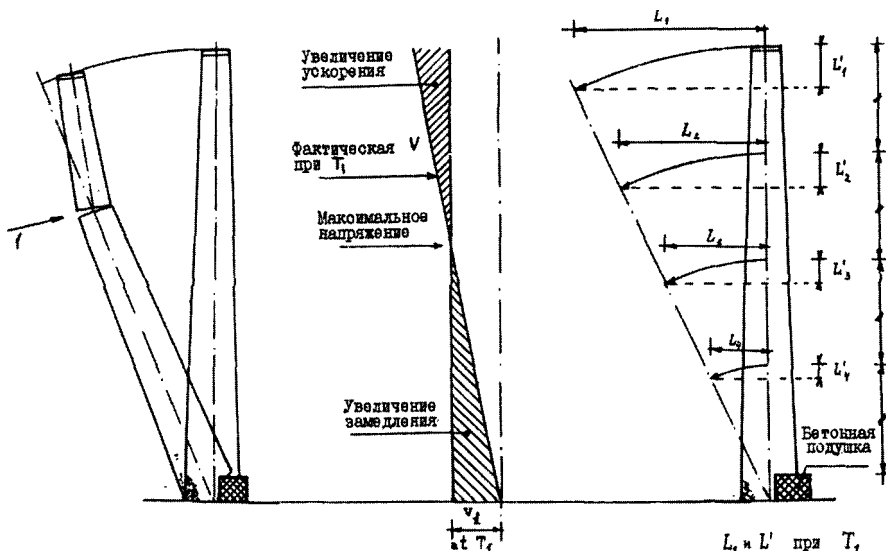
Эпюра напряжений при повалке монолитной железобетонной трубы:
